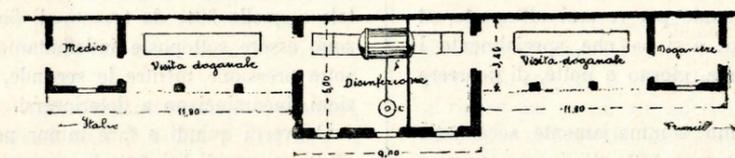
Pianta dello Stabilimento delle disinfezioni.
